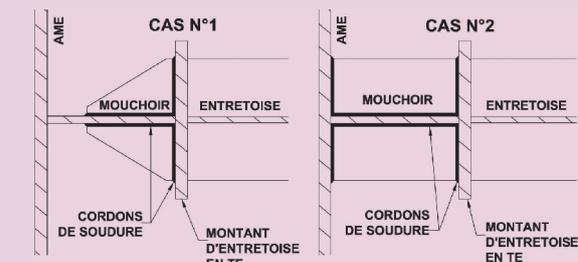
Mouchoirs d'entretoises horizontaux
